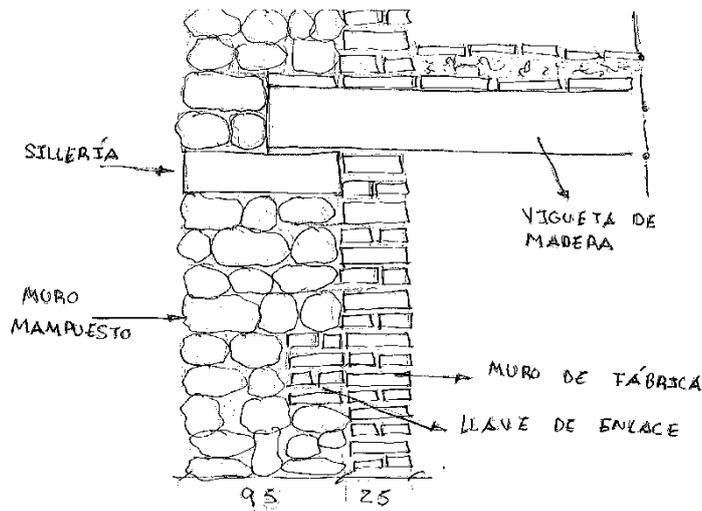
Sección de encuentro del muro con forjado de viguetas.
